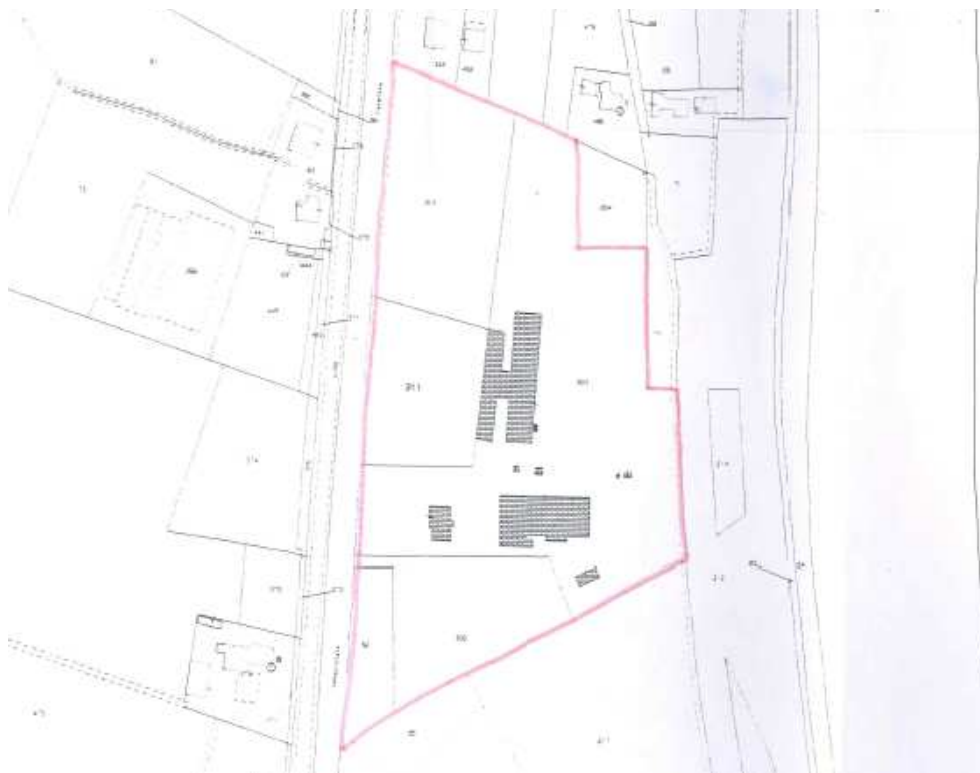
/3 – Planimetria dell'area con indicati gli edifici allo stato attuale
